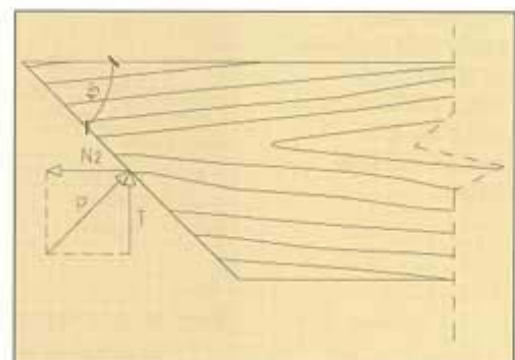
Schema delle azioni agenti sulla sezione della trave (profilo).
